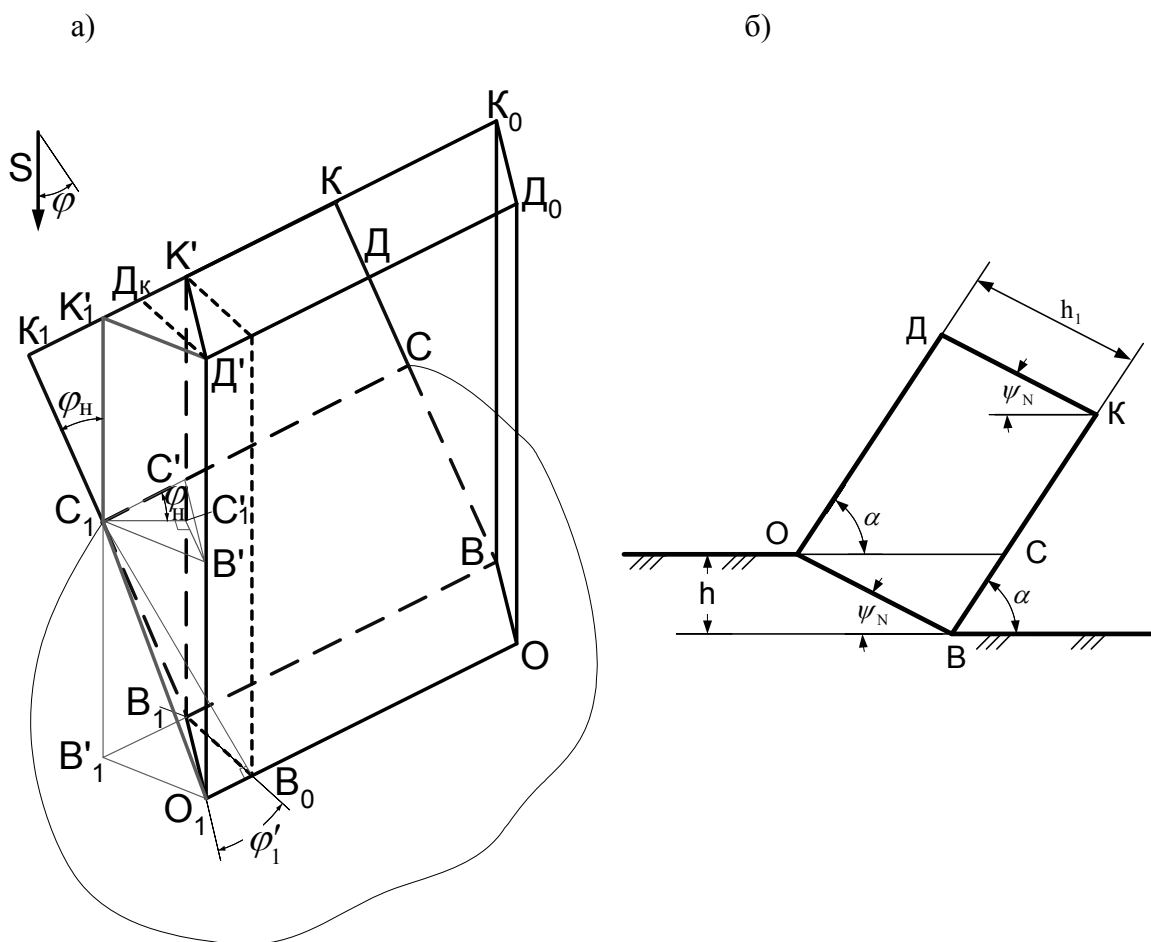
Схема для расчета объема грунта, перемещаемого по ножу (а); поперечное сечение грунта (б)
